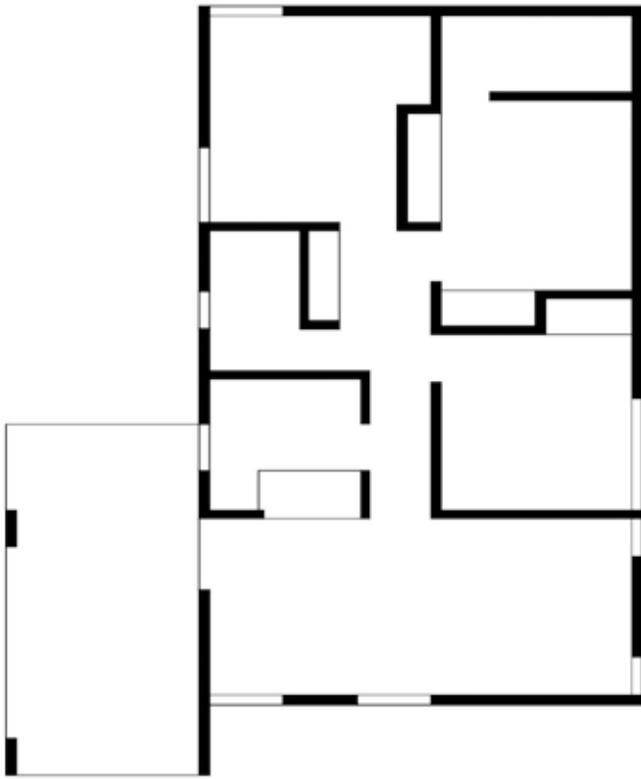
Planta de piso típica de vivienda estandarizada en Puerto Rico.
